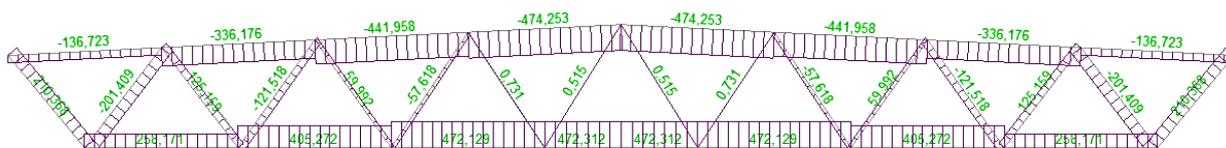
а – Эпюра продольных усилий в стержнях фермы
